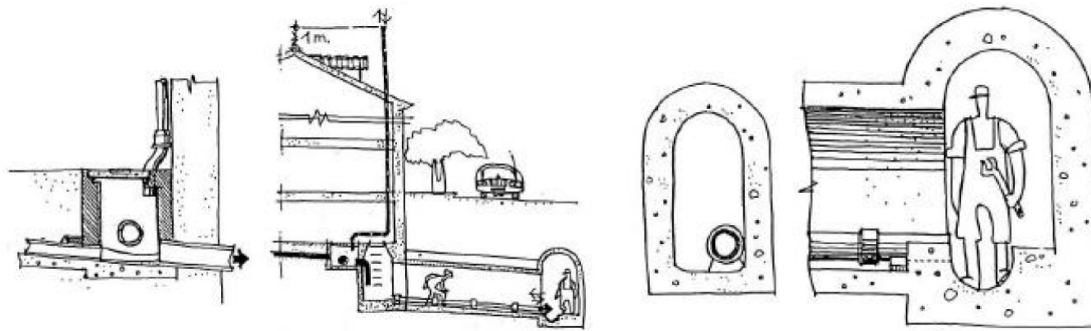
Acometida con tubería enterrada y con galería visitable. Fuente: ROCA, 2009.
